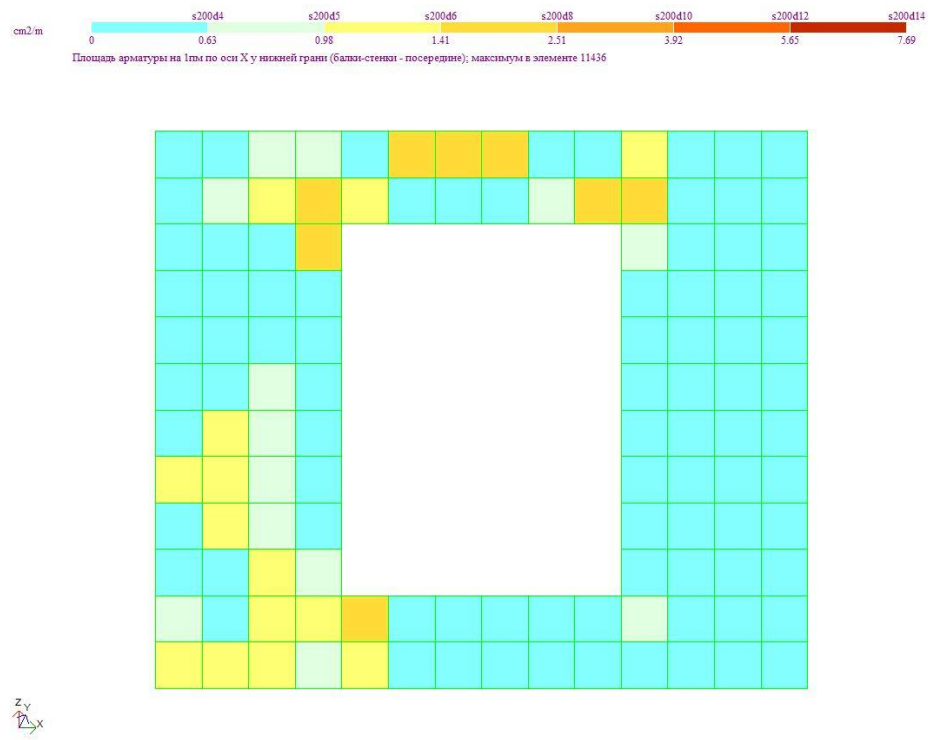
Армування панелі по осі А÷2-3(по X у нижньої грані)
